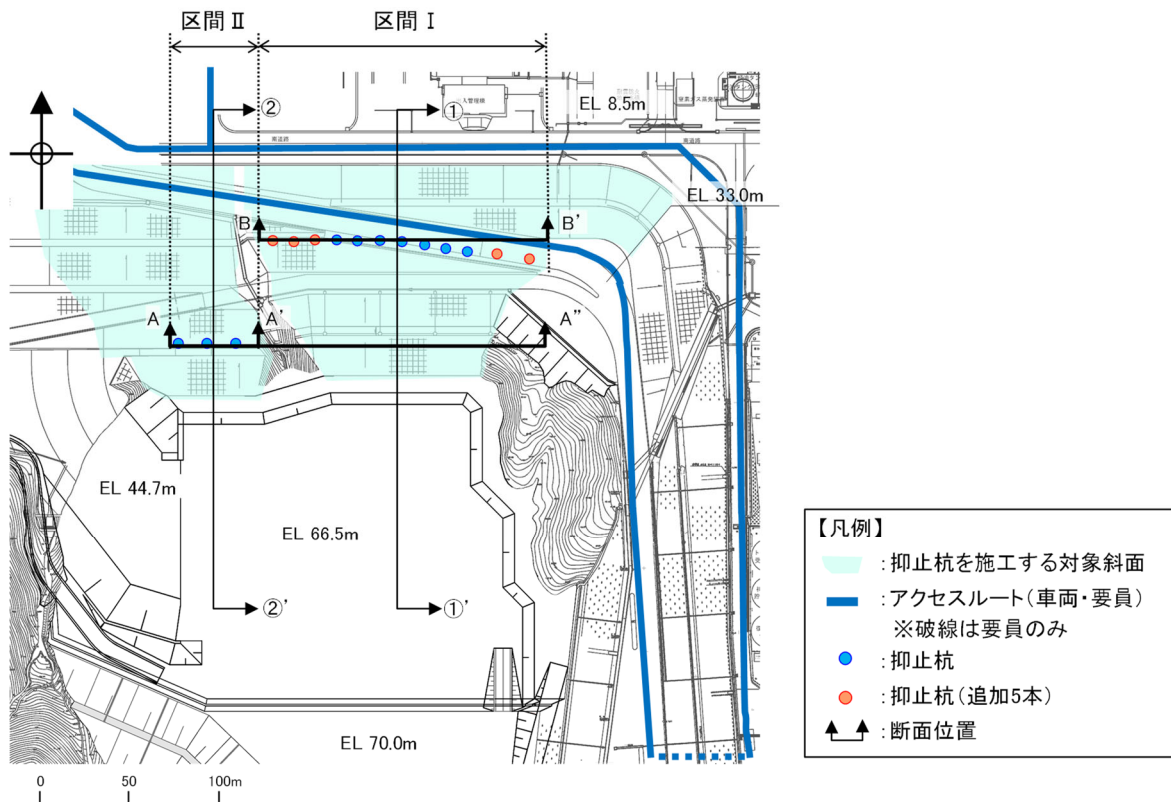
区間Ⅰ及び区間Ⅱの断面位置平面図
